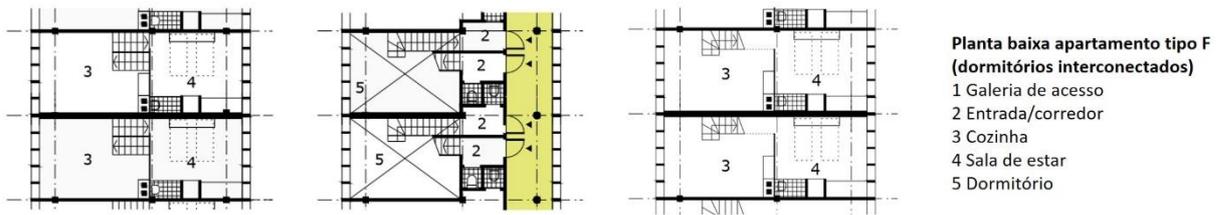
Plantas baixas apartamento tipo F- Narkomfin.
